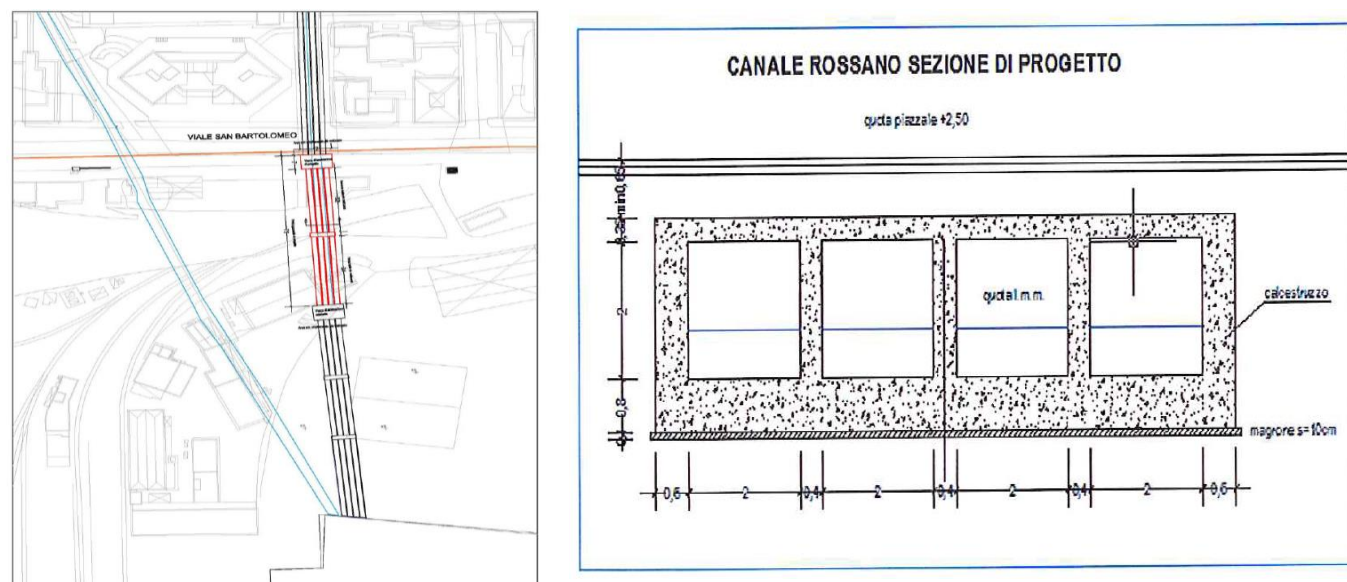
Adeguamento idraulico del Fosso Rossano (planimetria e sezione trasversale del tombamento di progetto).
